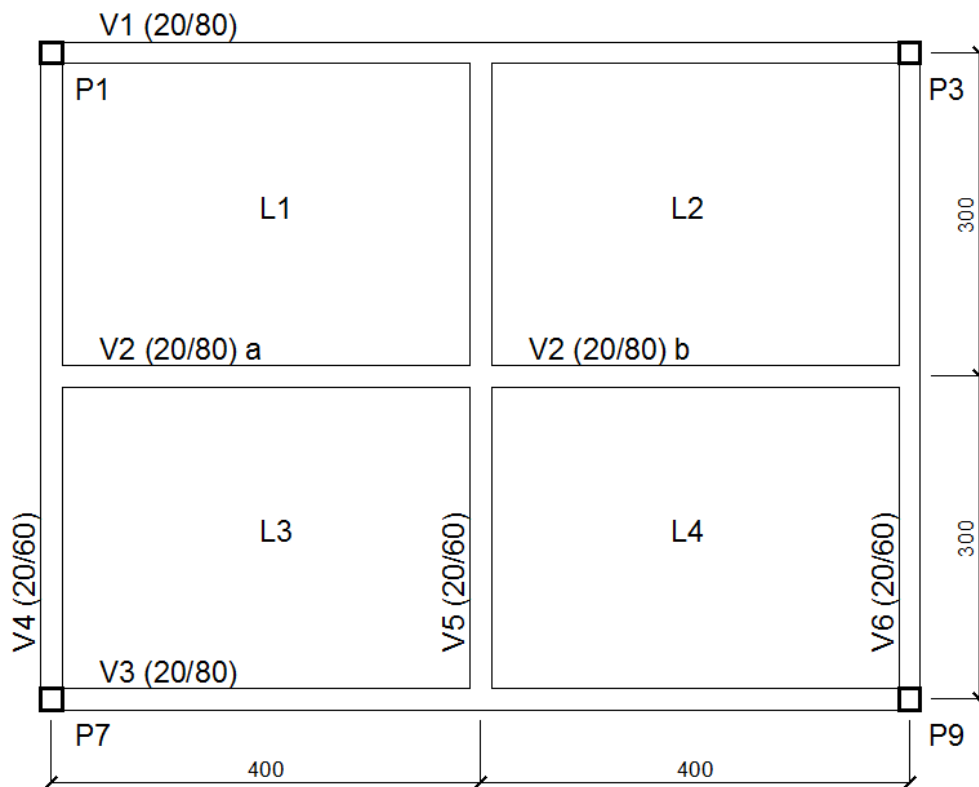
Exemplo 3 - Planta esquemática da forma do pavimento.
